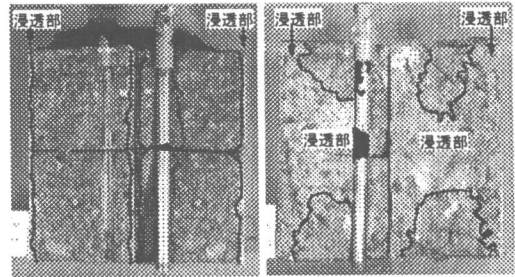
塩化物イオン浸透・鉄筋腐食状況 (左:コンクリートA, 右:コンクリートE)
